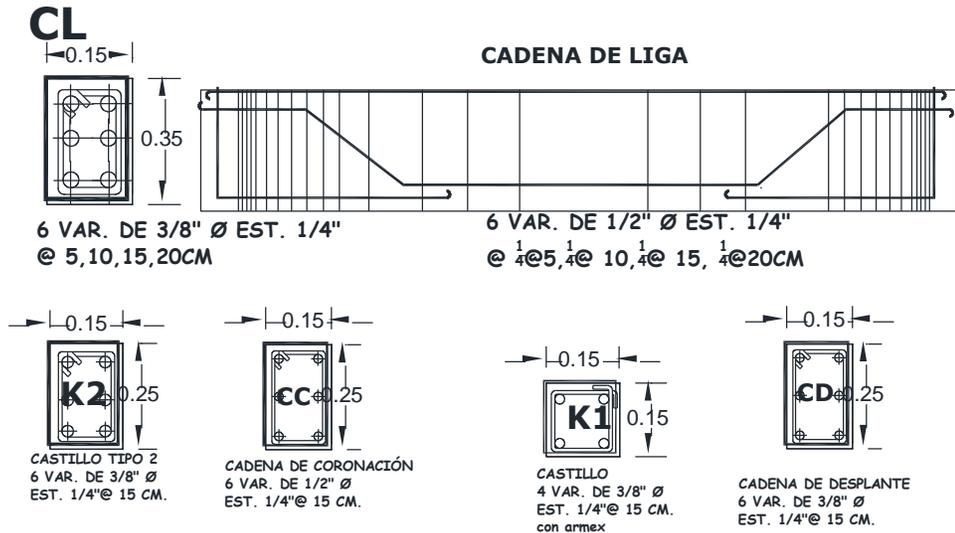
Tipos de castillos, cadenas y cadenas de liga
